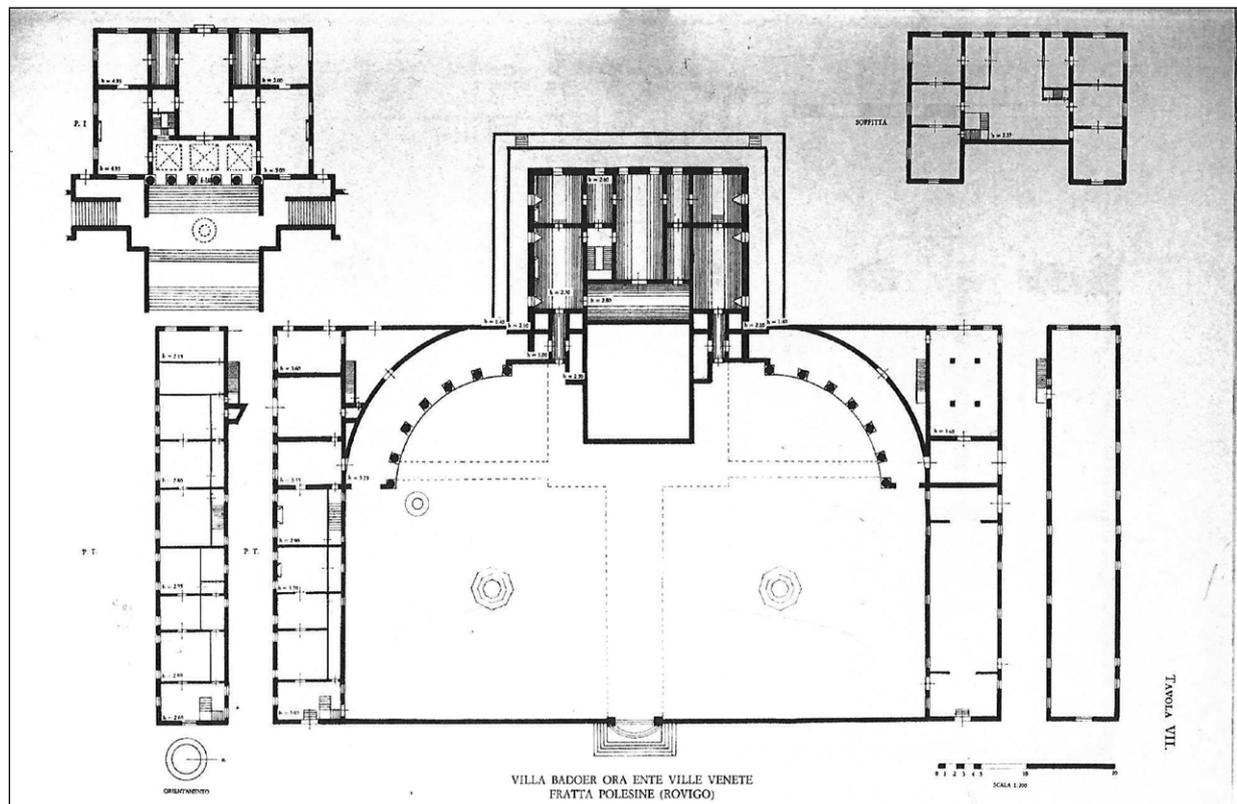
Planta do projeto construído, segundo Giangio Zorzi. Fonte: Zorzi. 1969.
